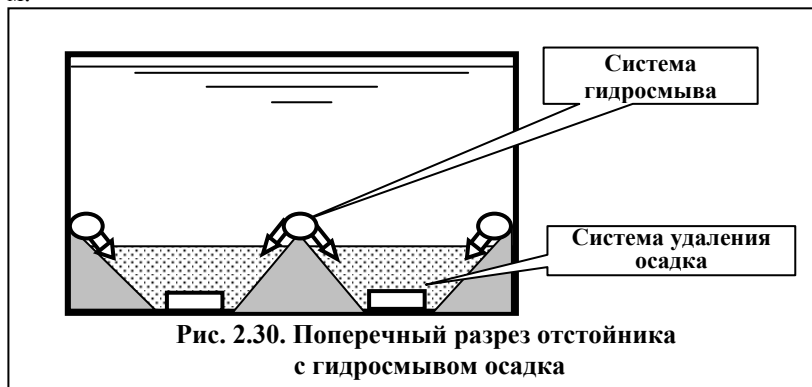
Поперечный разрез отстойника с гидросмывом осадка
